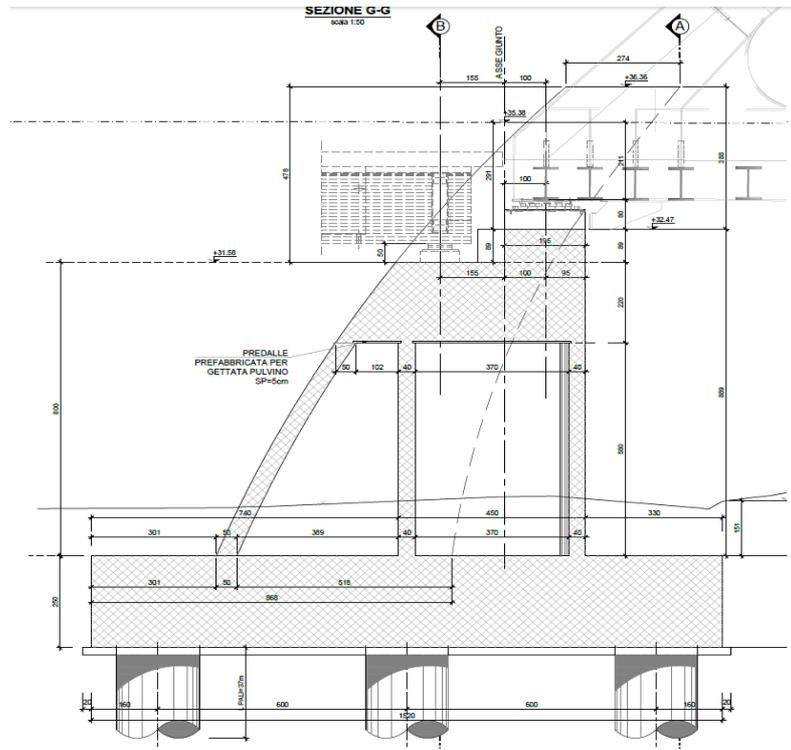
Pila P.27 VI.02 – sezione longitudinale
